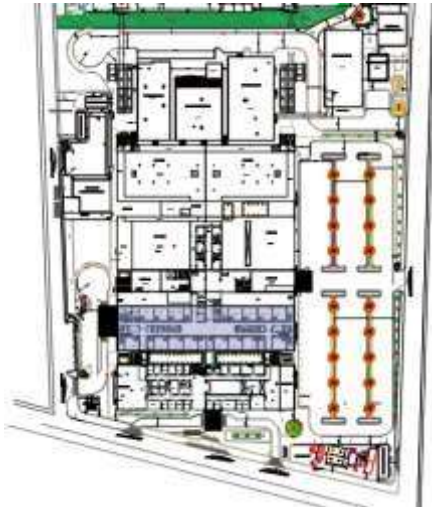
ZONIFICACIÓN DE AREAS CRITICAS HDTC PLANTA BAJA
